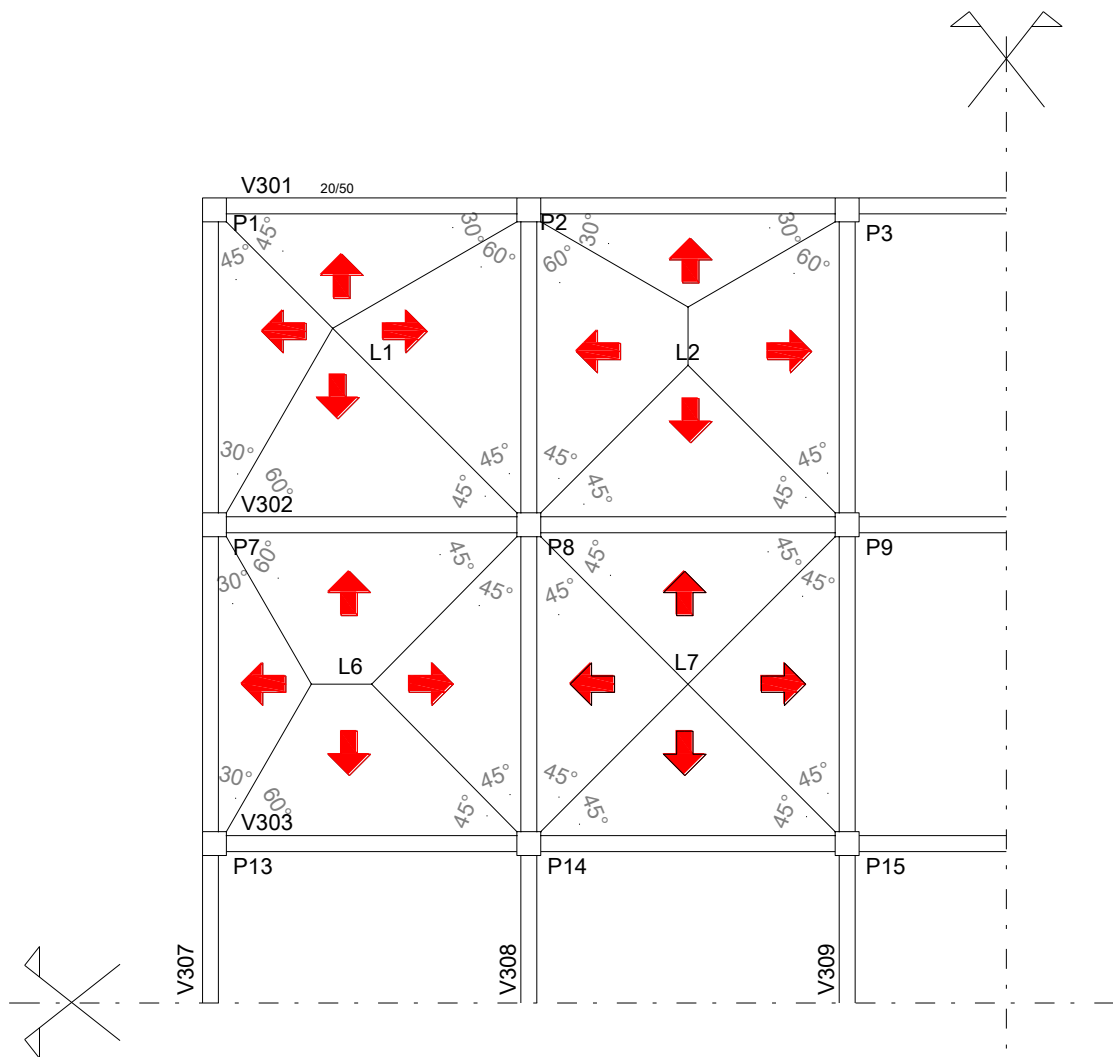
Distribuição do carregamento vertical das lajes L1, L2, L6 e L7 para as respectivas vigas de acordo com o tipo de apoio de cada bordo das lajes
